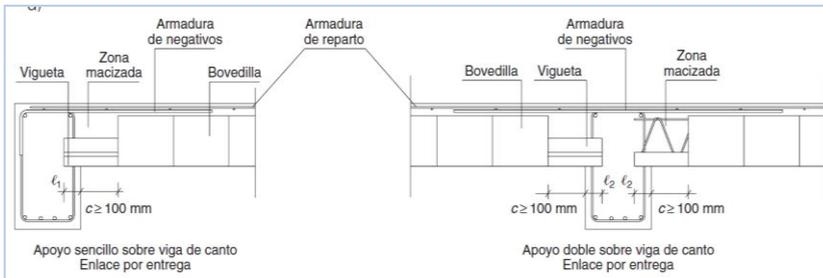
y 14. Apoyo sobre viga de canto. Enlace por entrega
